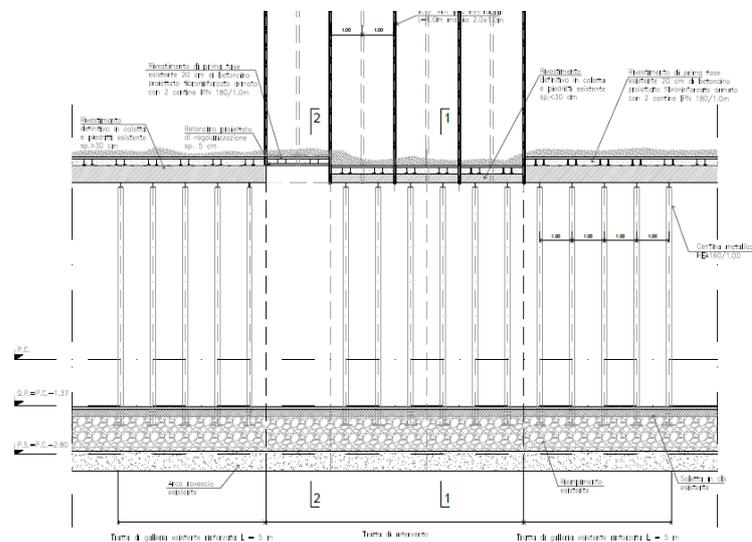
Galleria Guinza – Intervento Tipo A – Sezione corrente – Scavo – Profilo
